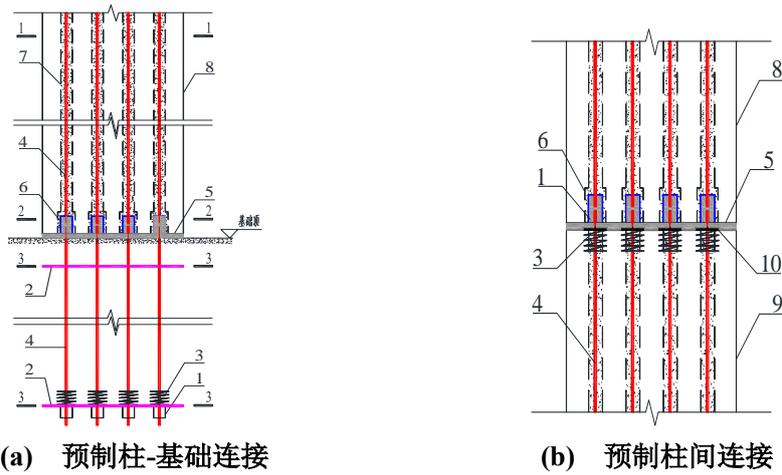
采用后张有粘结精轧螺纹钢筋竖向构件连接构造示意图
